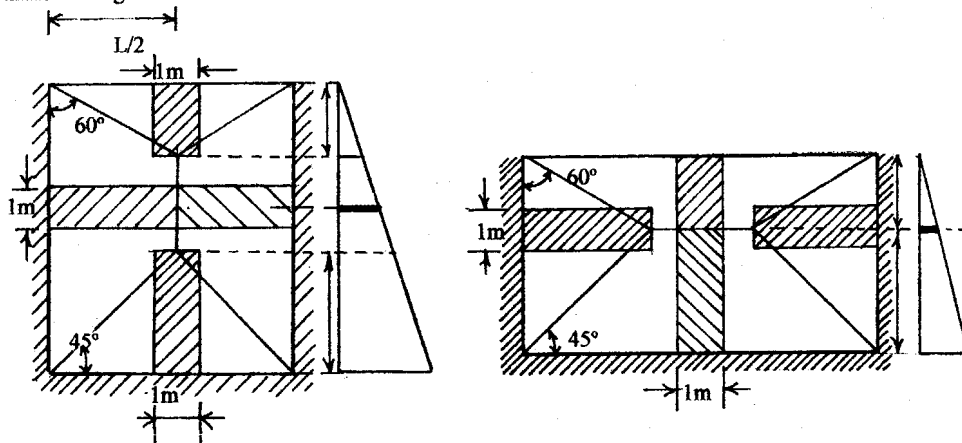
Determinación de esfuerzos de tracción en paredes y fondo
